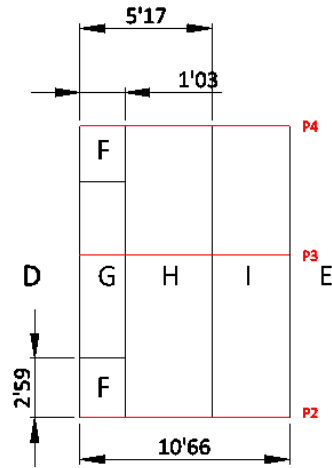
Modelo de cargas debidas al viento lateral sobre los pórticos de la segunda planta.
